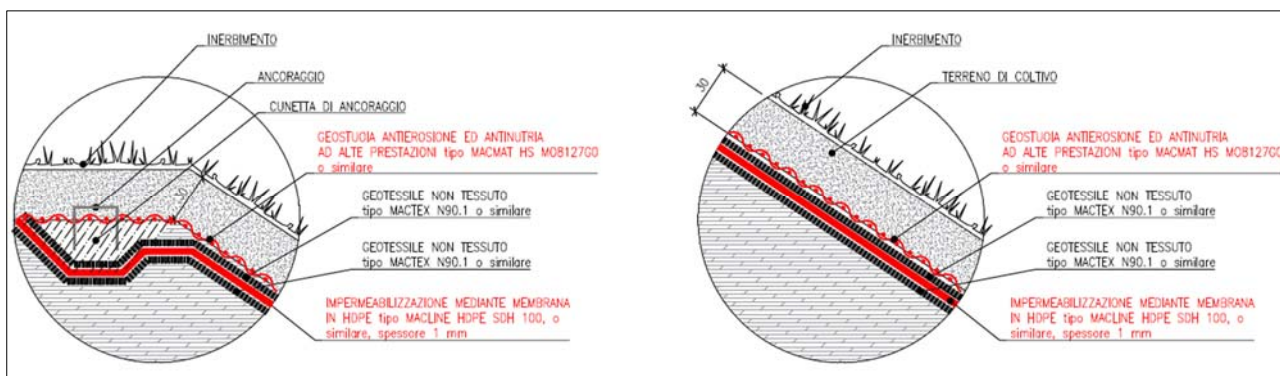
Particolare del sistema di impermeabilizzazione del rilevato lato fiume.
